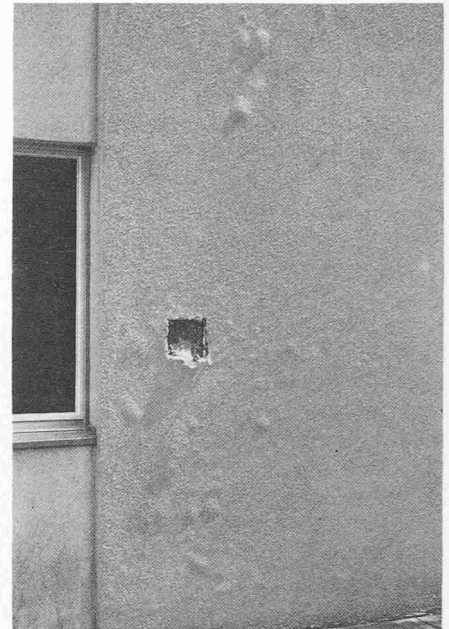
Saniertes Mehrfamilienhaus. Fassadenausschnitt: Blasenbildung
